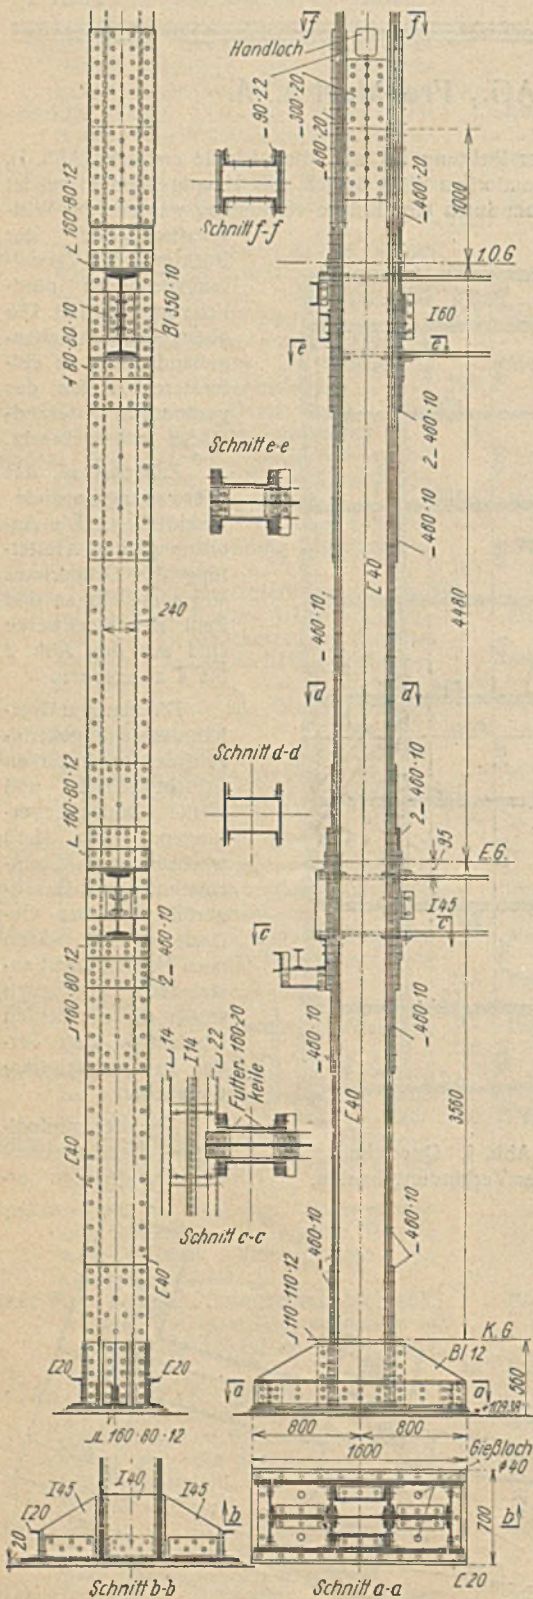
Konstruktive Durchbildung d. Rahmenstiele der Querflügel mit biegefesten Unterzuganschlüssen.
